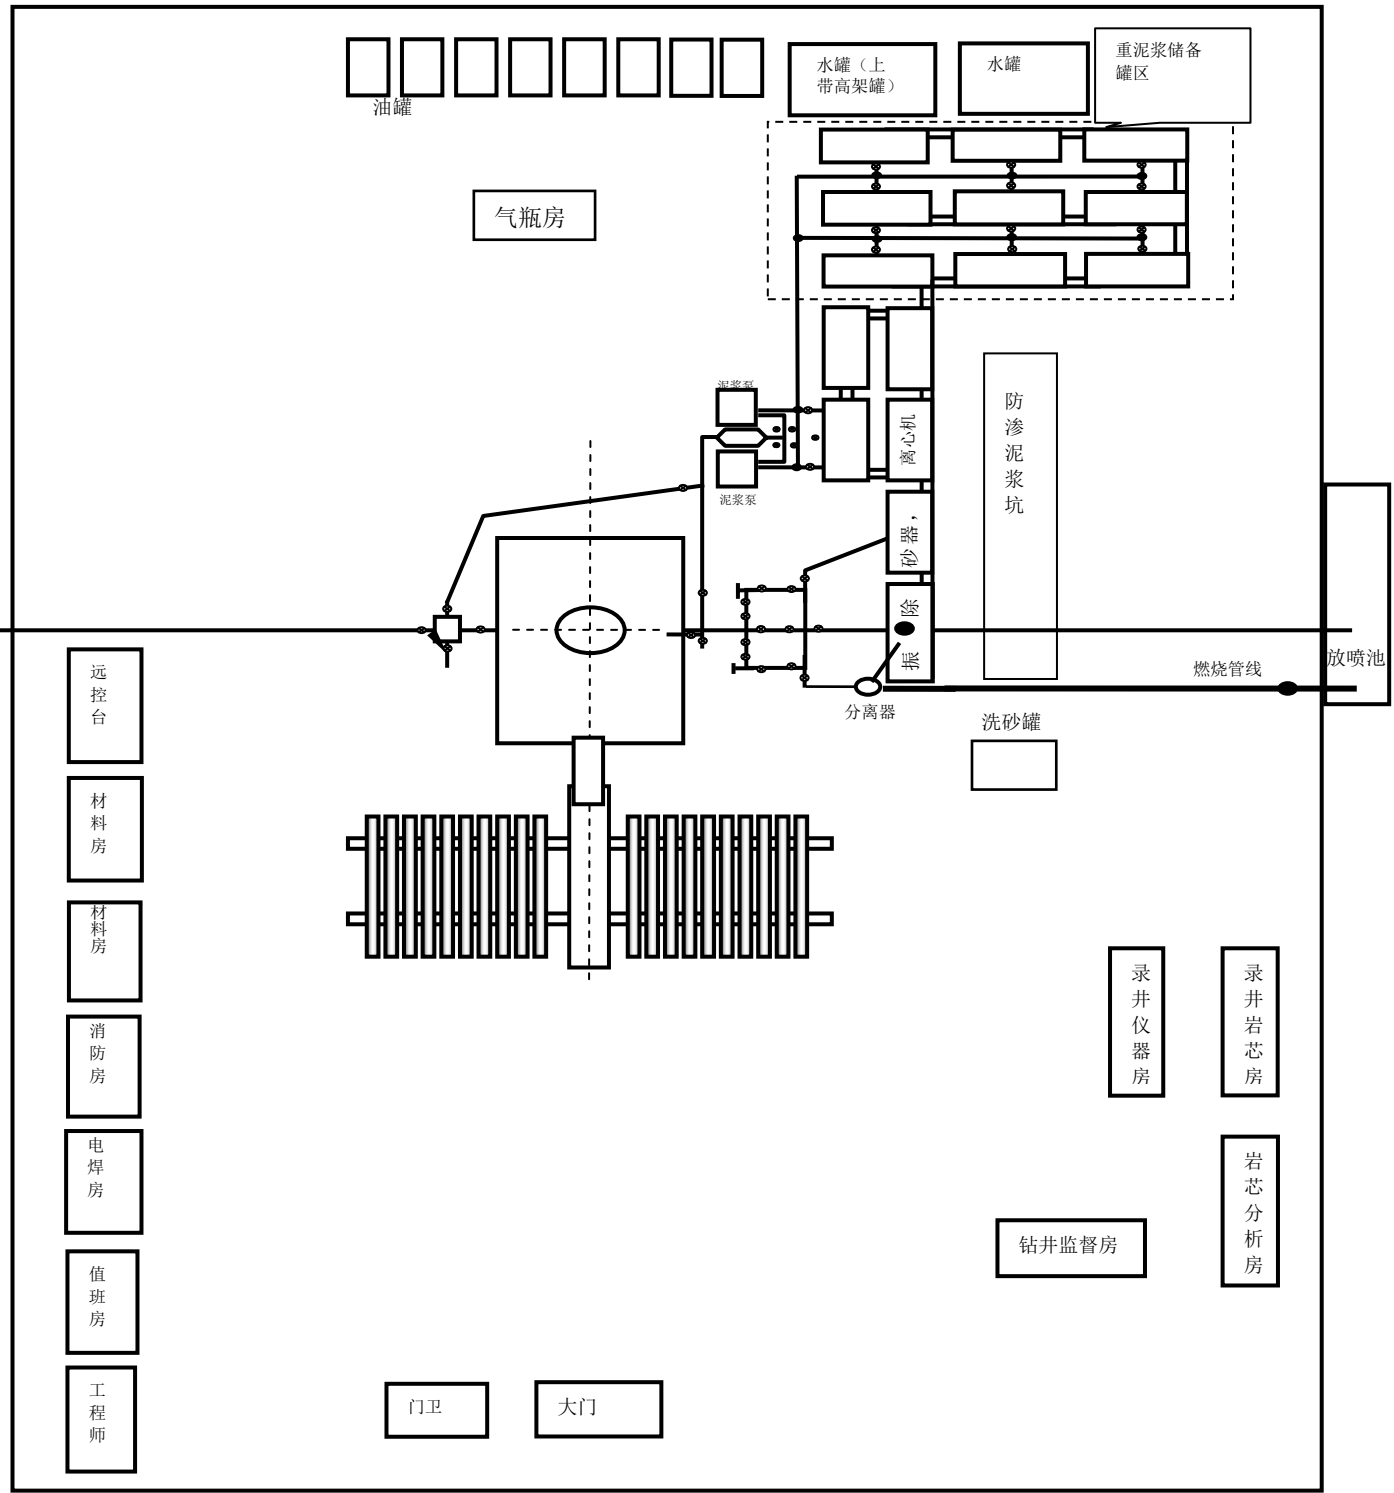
(a) 设泥浆池钻井井场典型的平面布置图
